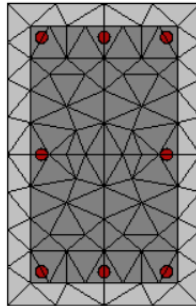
Sección de columna de pórtico discretizado en 150 fibras usando SeismoStruct v6.
